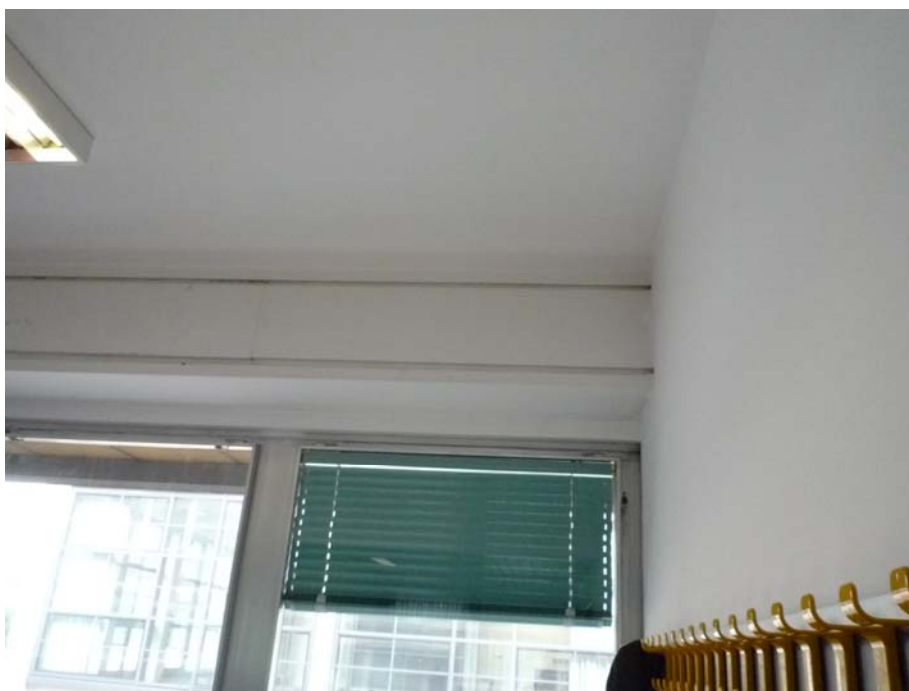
Piano Terra e primo – Cassonetto in ferro.
